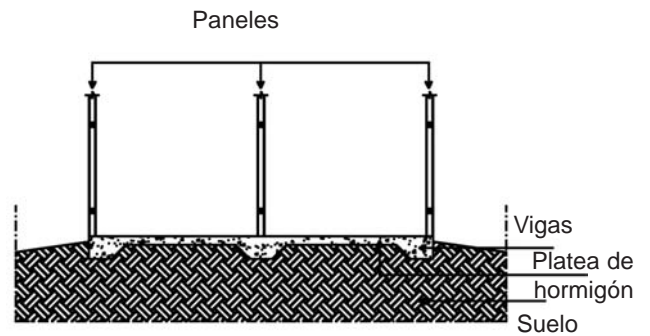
Corte esquemático de una platea de hormigón (radier)
